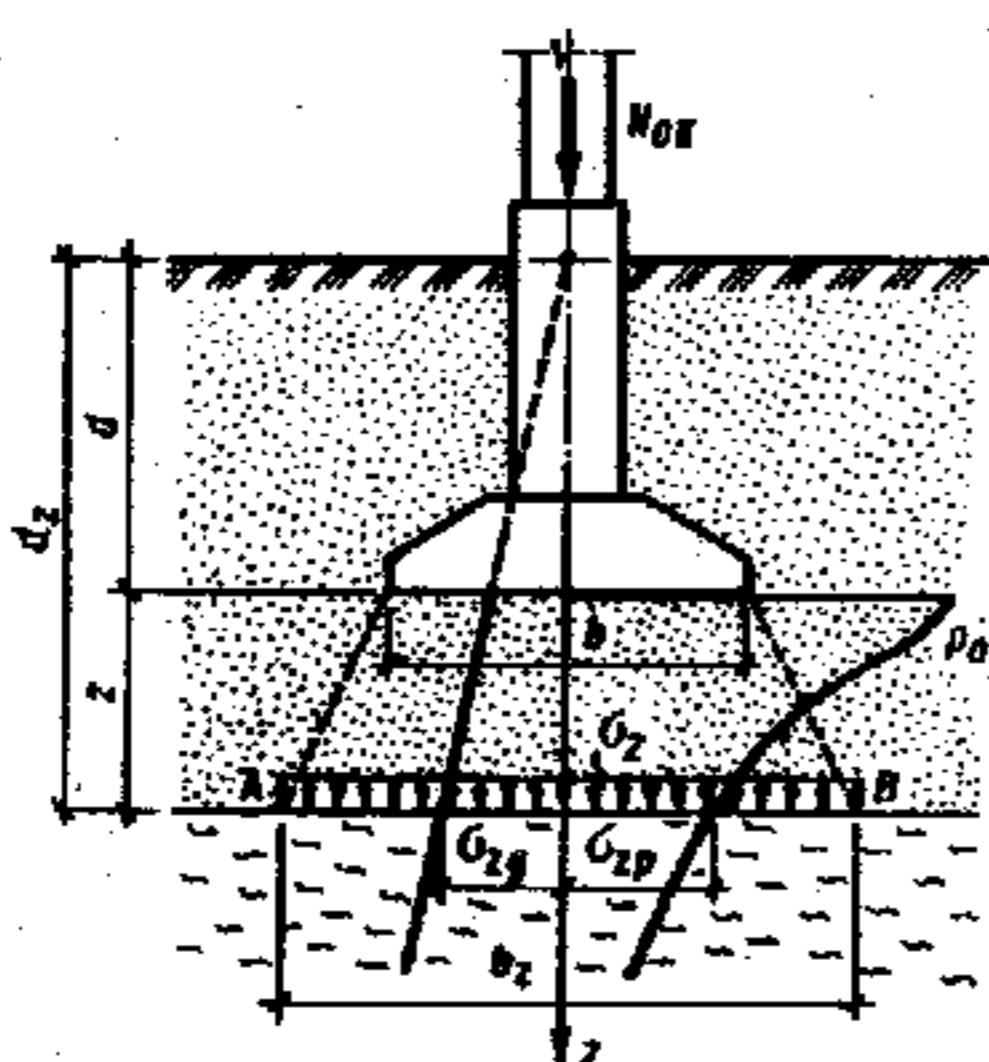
Расчётная схема к проверке давления на подстилающий слой слабого грунта
